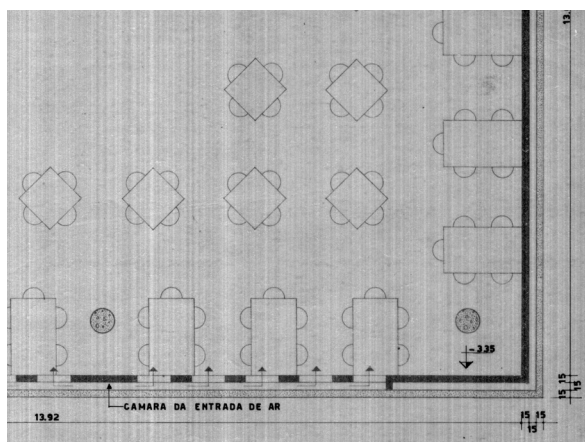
Projeto executivo original - recorte da Planta do Subsolo com câmaras de entrada de ar para ventilação Acervo IAB-SP
